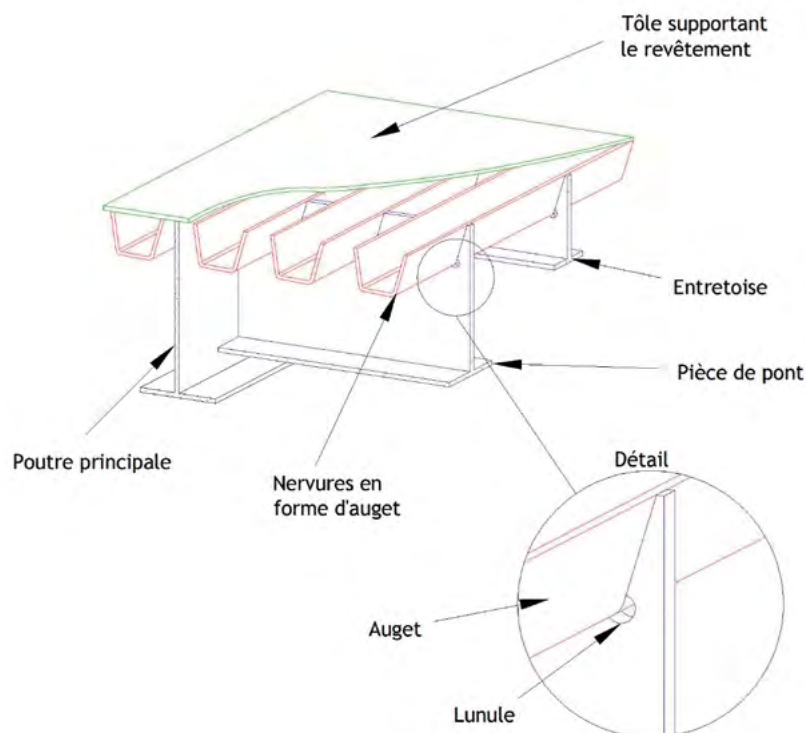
Coupe d'une dalle orthotrope avec des raidisseurs en forme d'auget
